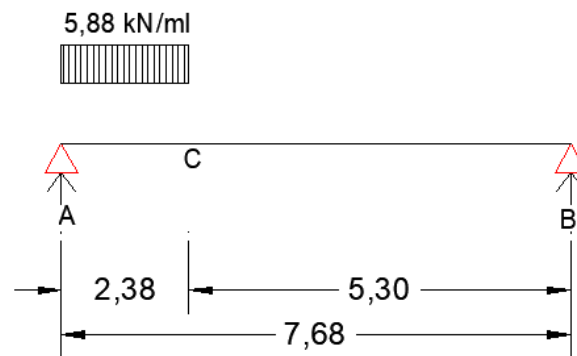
Viga biapoyada carga uniformemente distribuida longitud "a" 5,88 kN/ml
